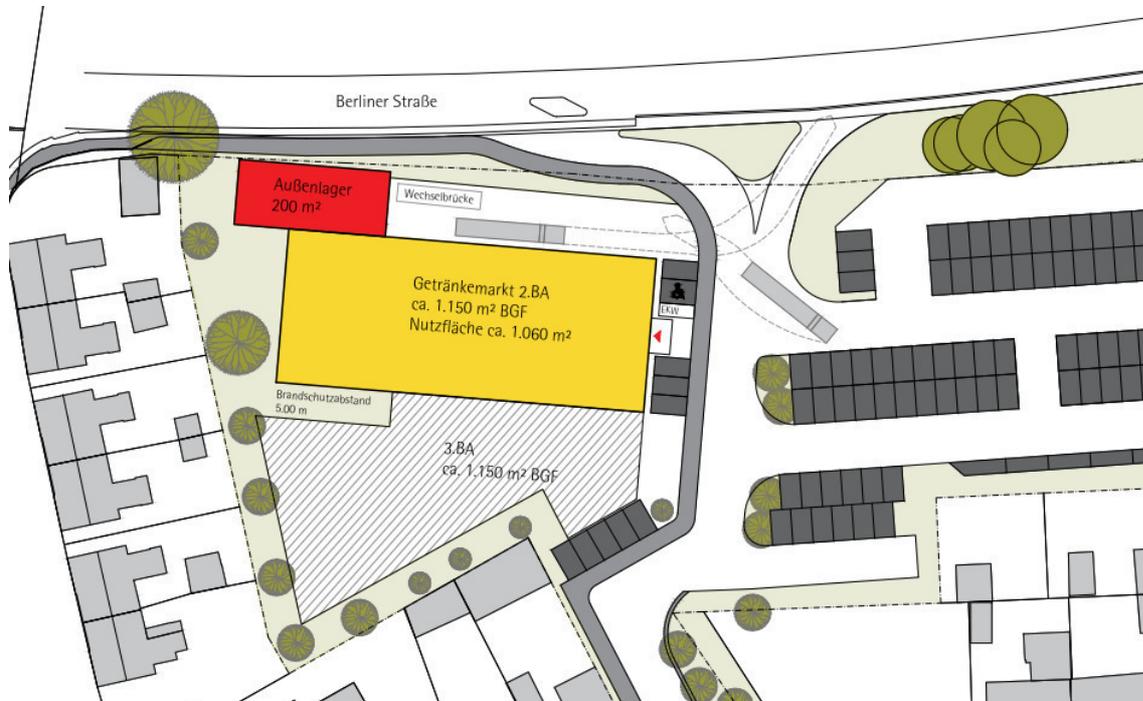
Lageplan des geplanten Getränkemarktes [1]
